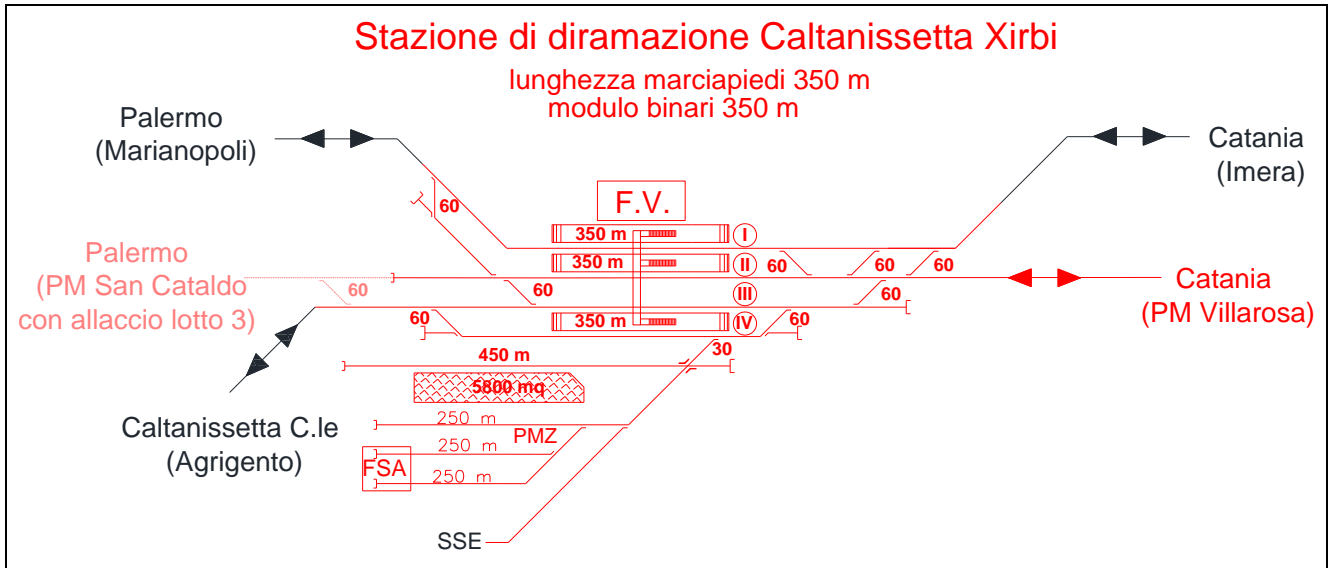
Layout funzionale di progetto – Stazione di Caltanissetta Xirbi
